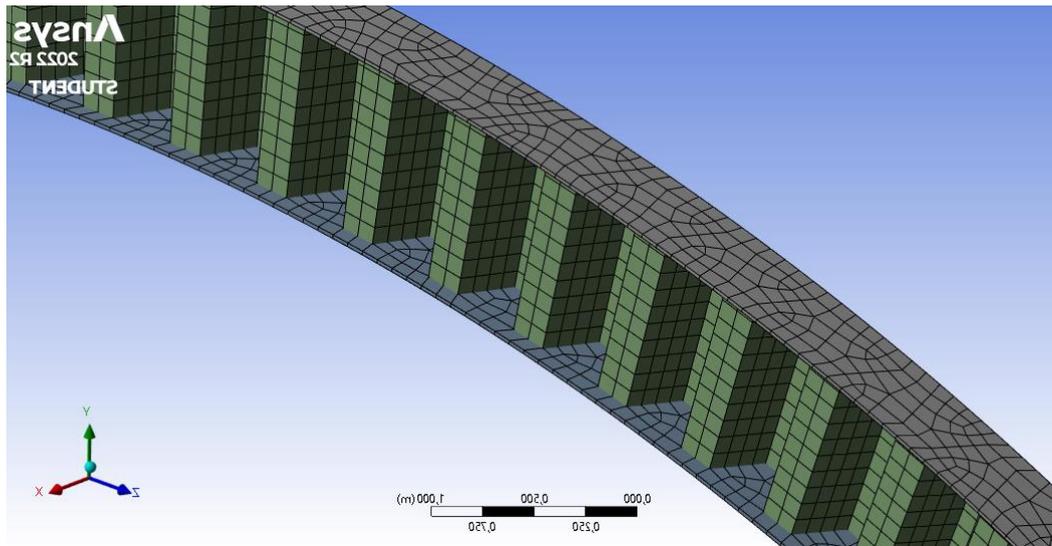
Detalle del mallado en el arco de alma corrugada trapezoidal.
